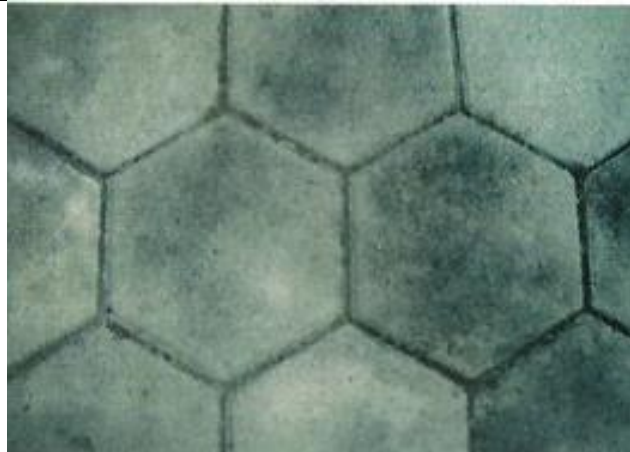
/04 – Foto de blocos sextavados de concreto assentados.
